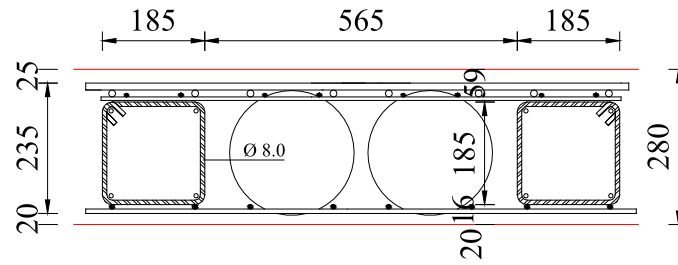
Detalhe da armadura de cisalhamento na laje BD1 (cotas em mm)
